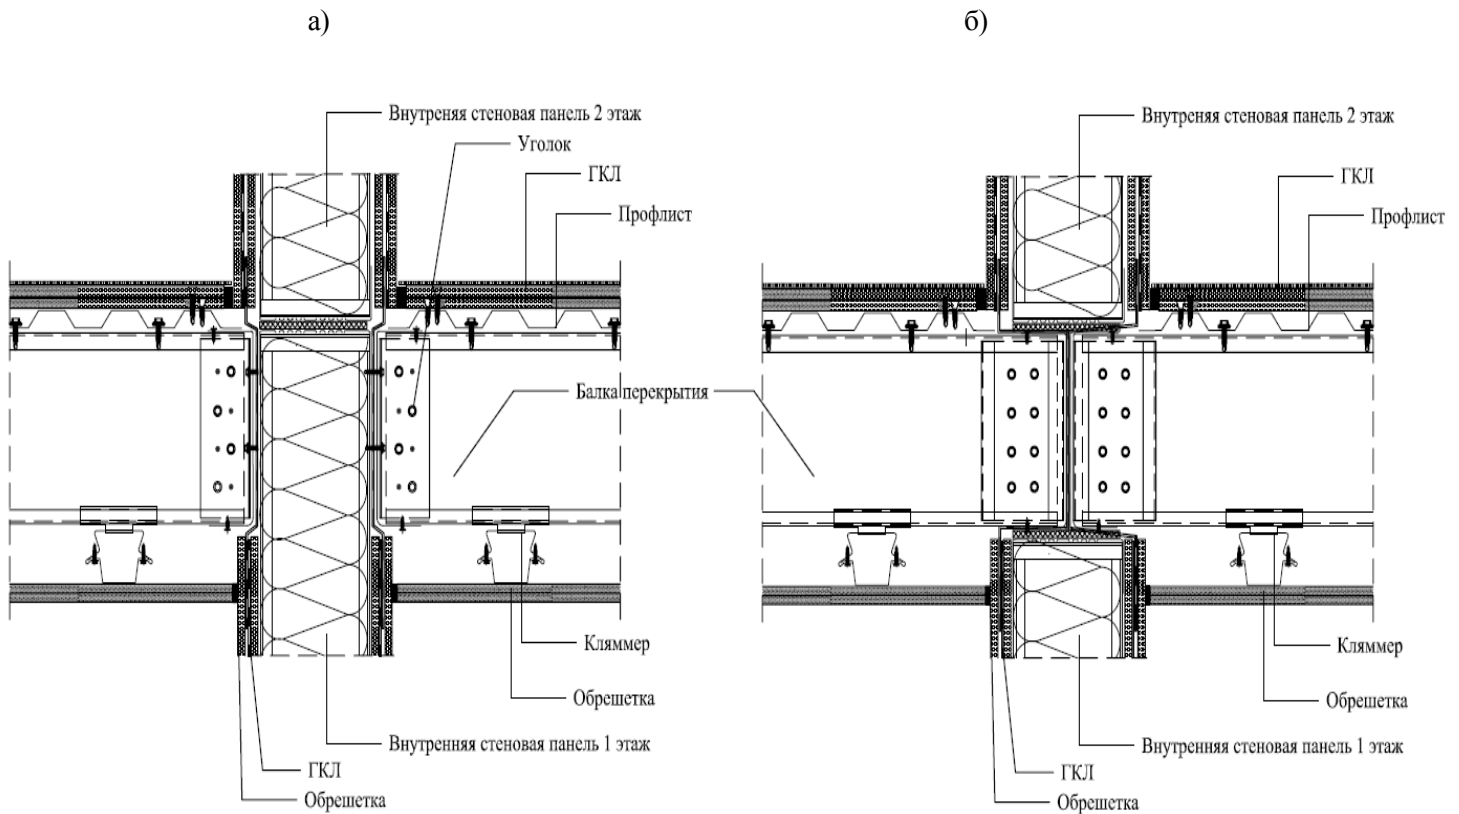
Узлы соединения междуэтажного перекрытия с внутренней стеной:
